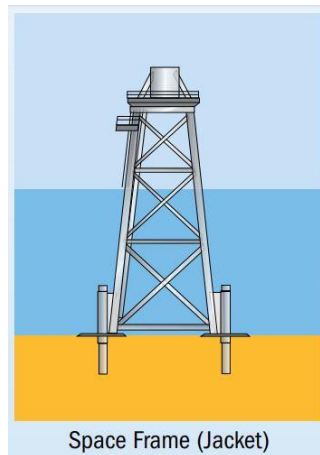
Estructura Jacket. Fuente: Informe “Deep Water”, EWEA
